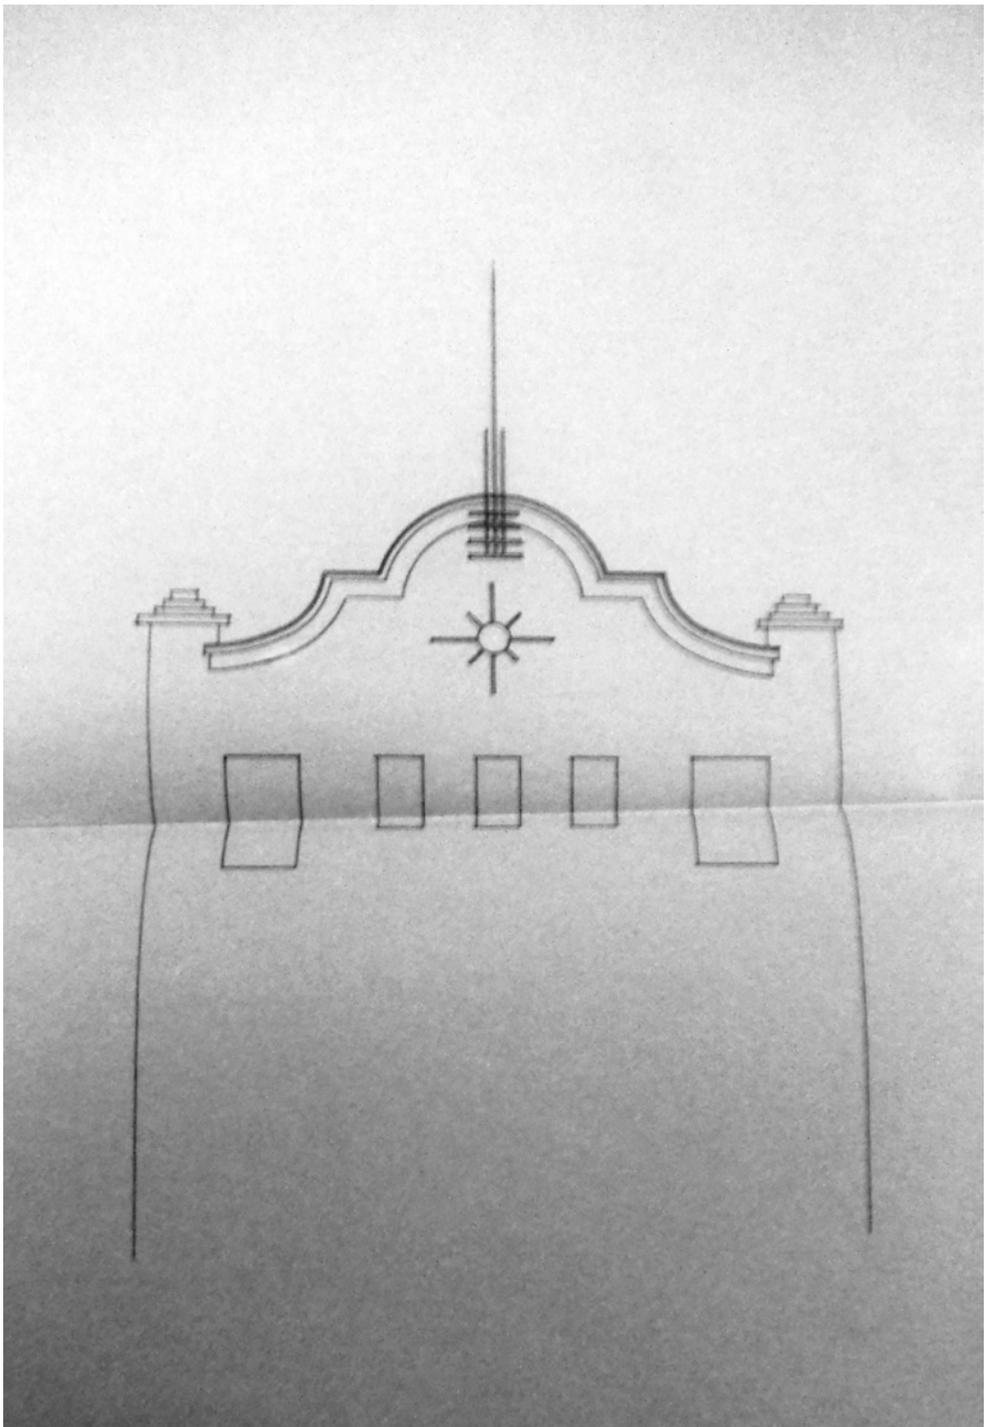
Plano de fachada de las Escuelas de Arriate. Detalle (Escala 1:100)
